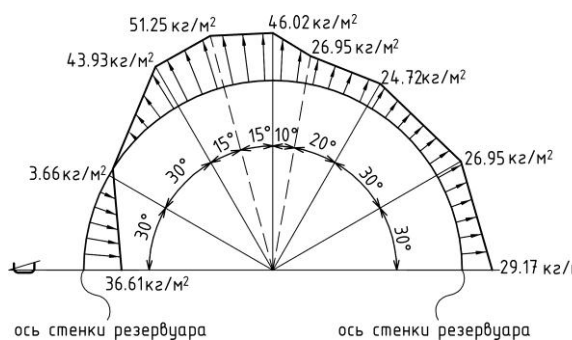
Схема приложения ветровой нагрузки на 7-й пояс стенки резервуара
